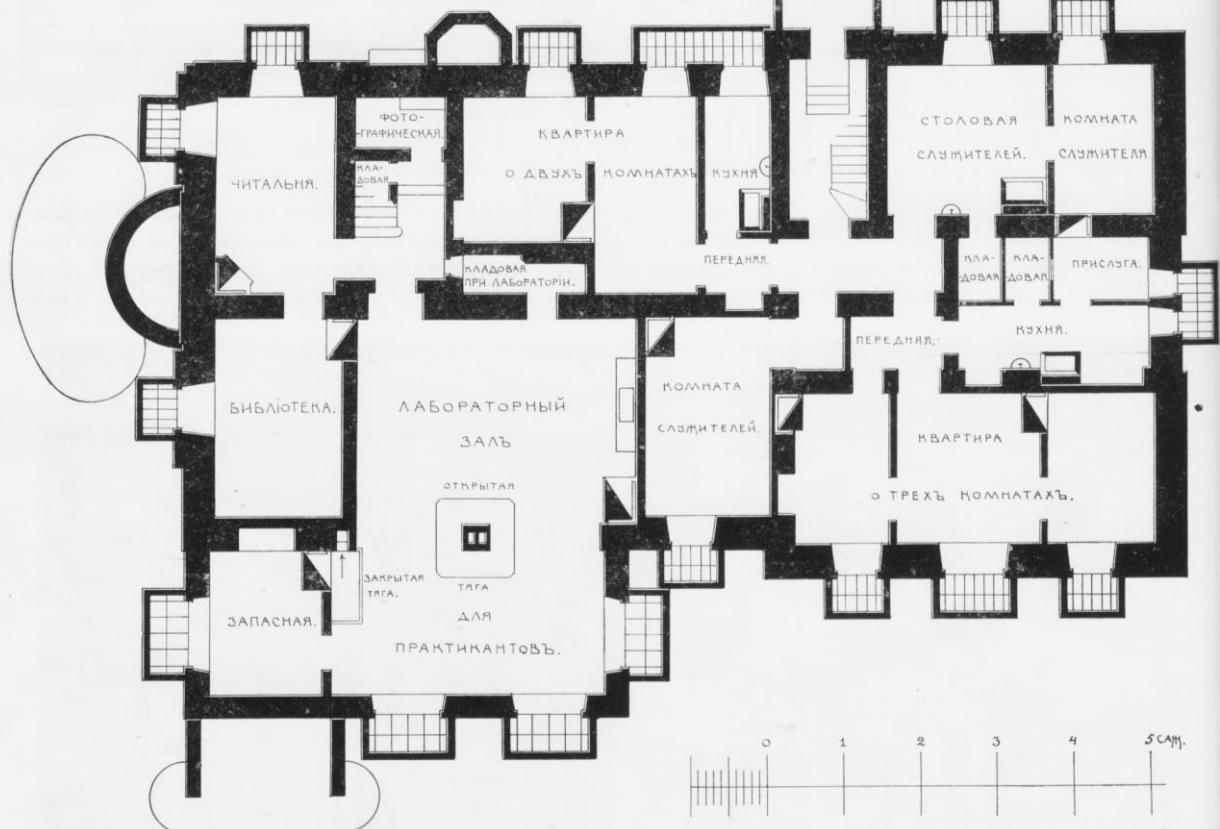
Главное зданіе Станціи. Планъ нижняго этажа (съ натуры).
